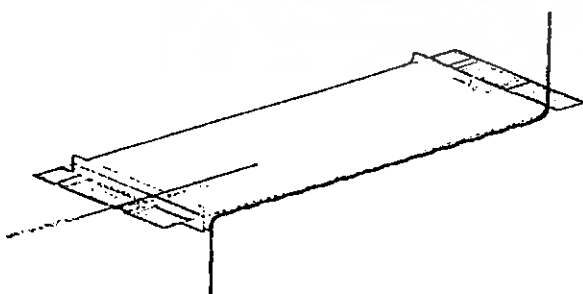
รูปแสดงผังชั้นหลังคา
